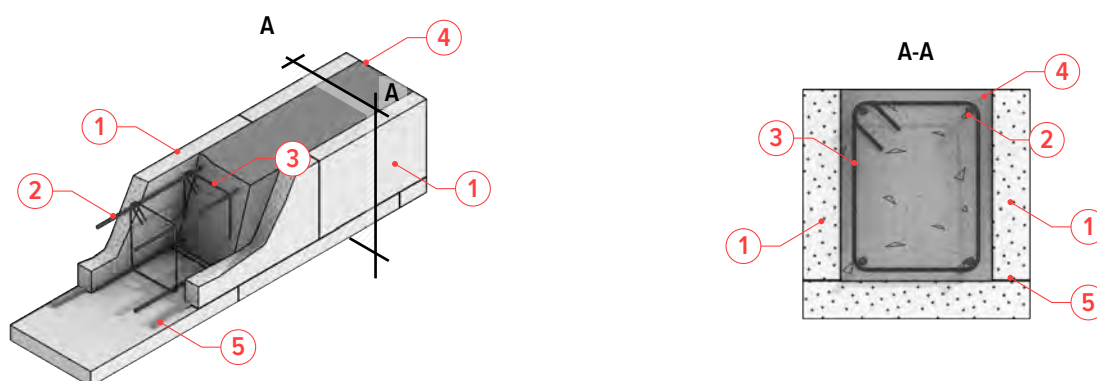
Железобетонный пояс с опалубкой из двух перегородочных блоков 50 мм
